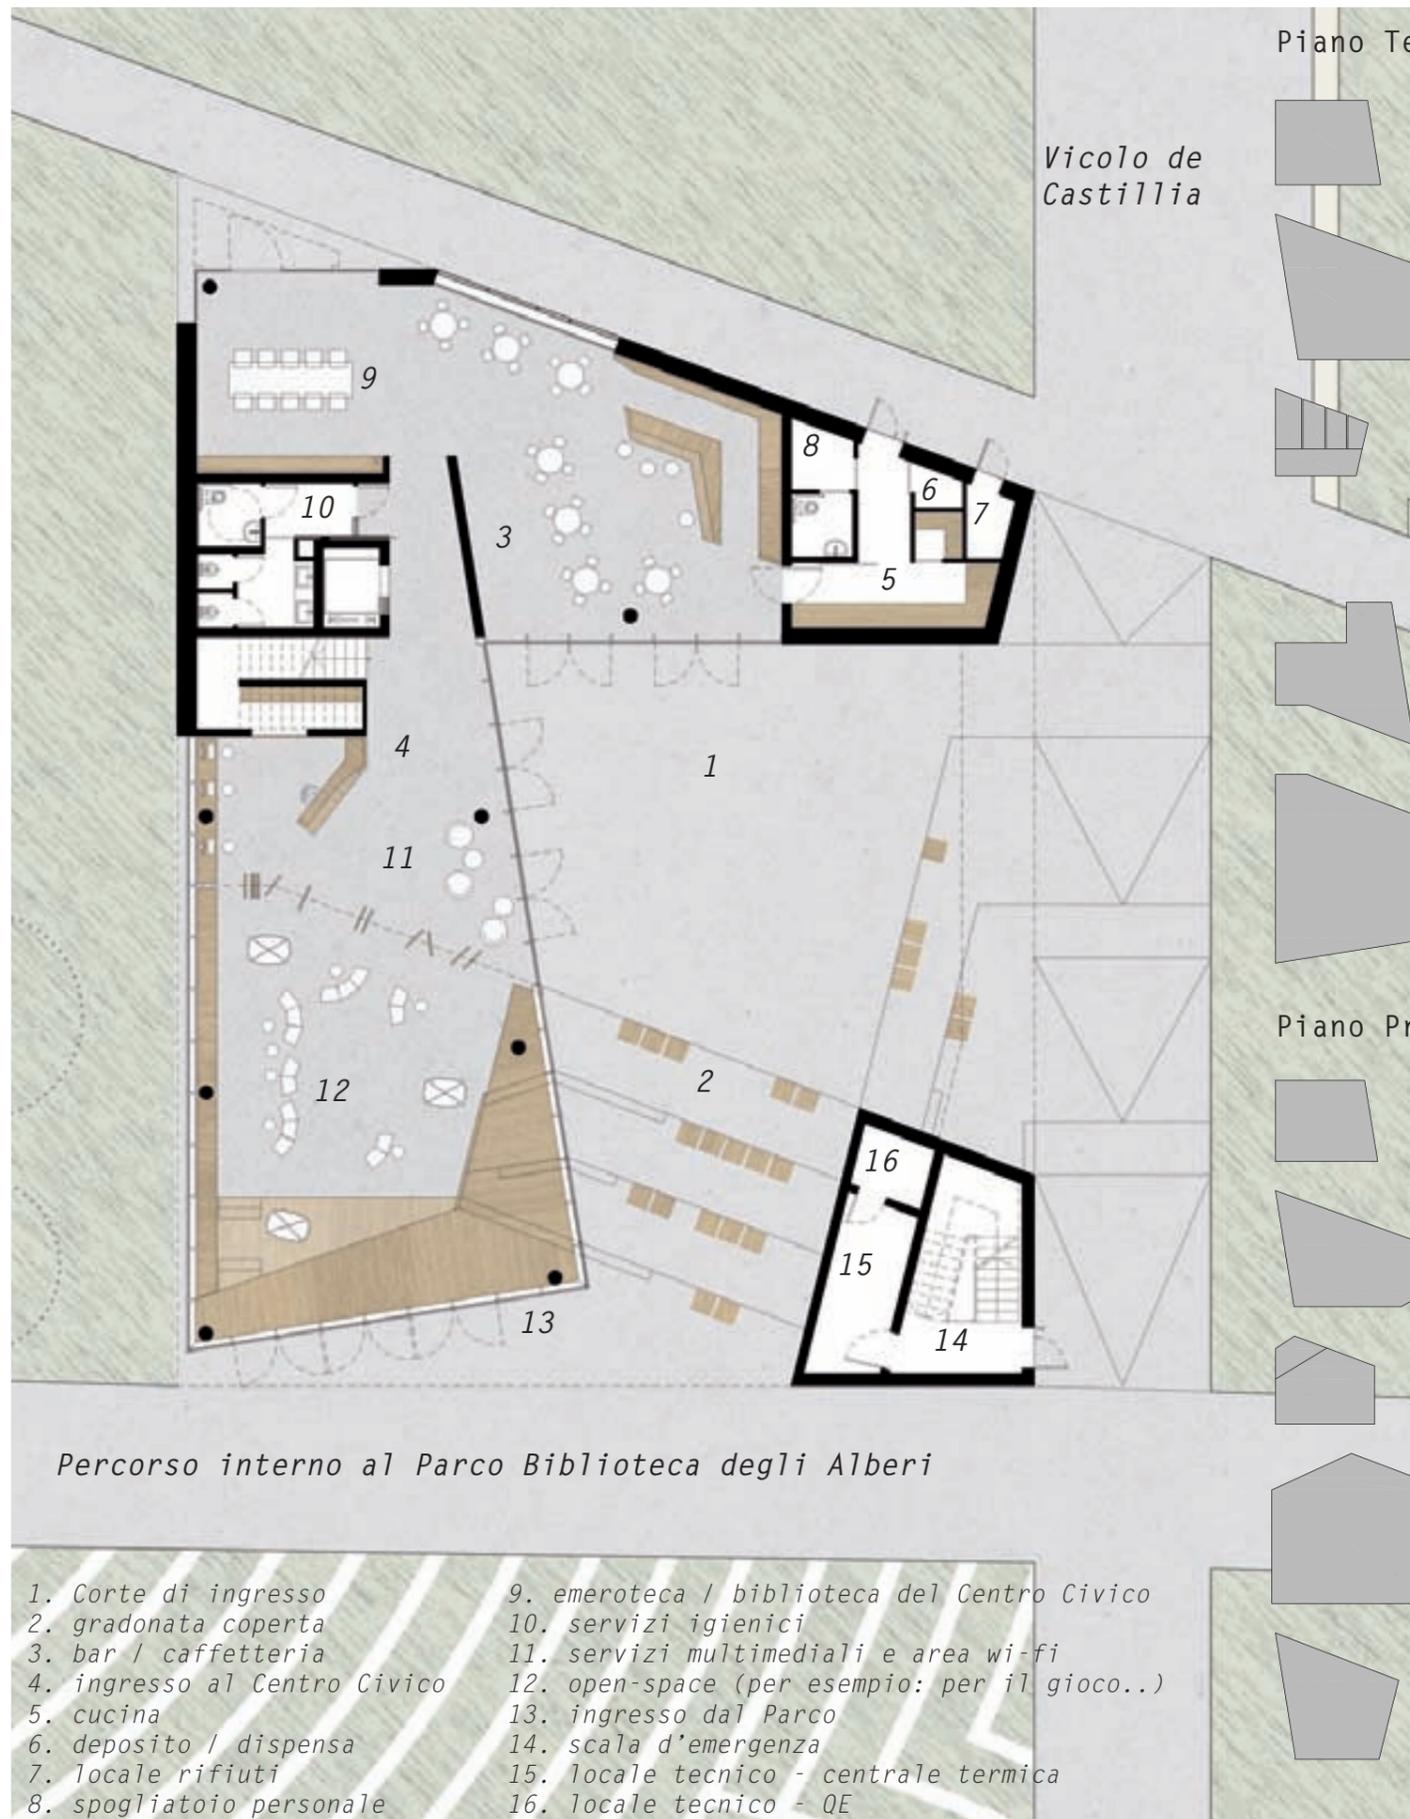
| Pianta del Piano Terra (quota: + 0,18; ingresso in piano dalla Corte).
